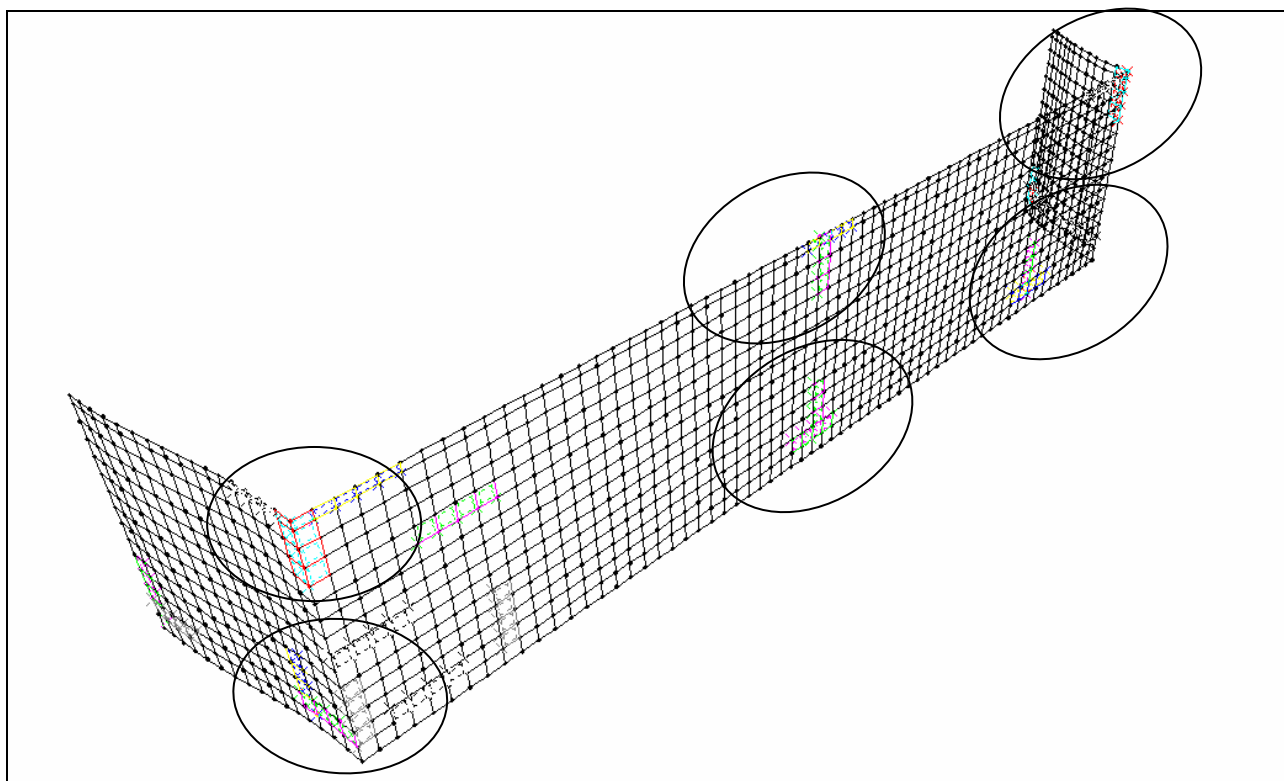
posizione delle section cuts sui muri della spalla.
